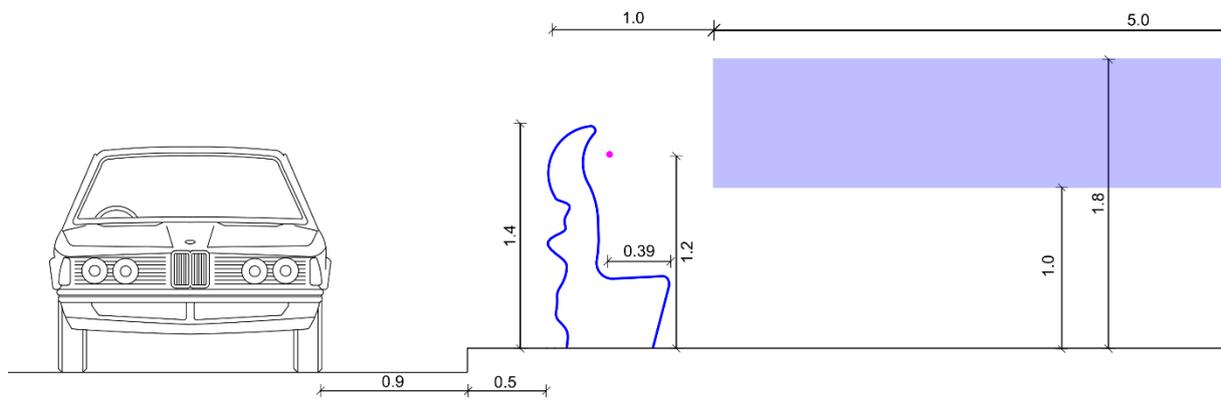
Coupe schématique du principe constructif avec assemblage de panneaux bois et positionnement des récepteurs de calculs.
